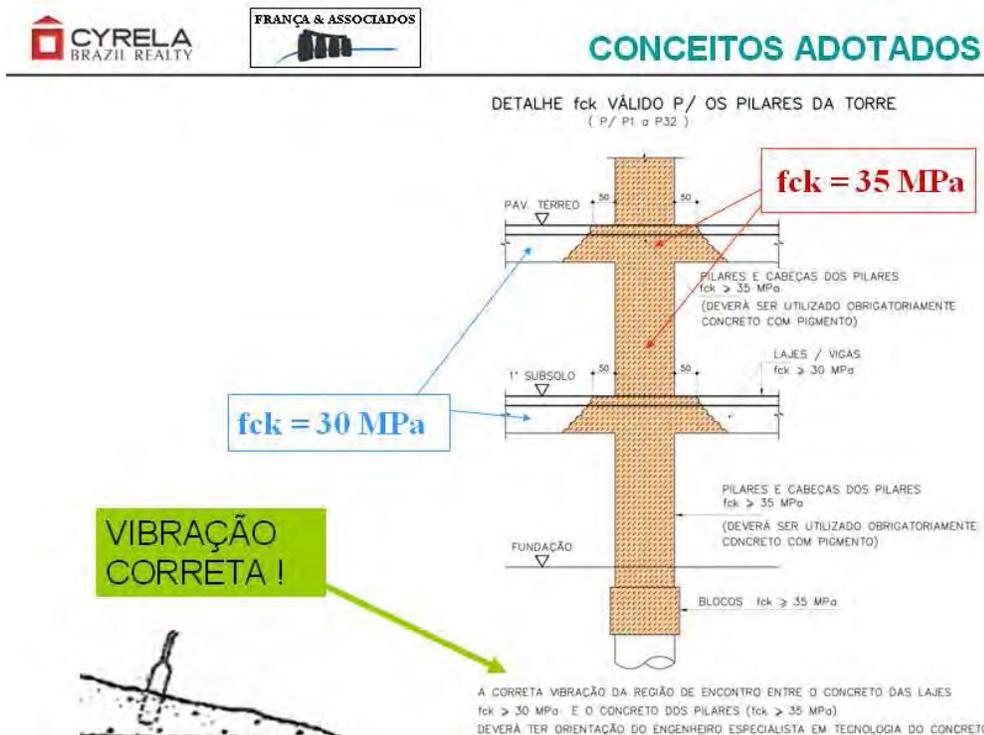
Exemplo da apresentação do projetista estrutural - Indicação do fck dos pilares e lajes – Fonte: FRANÇA & ASSOCIADOS.
